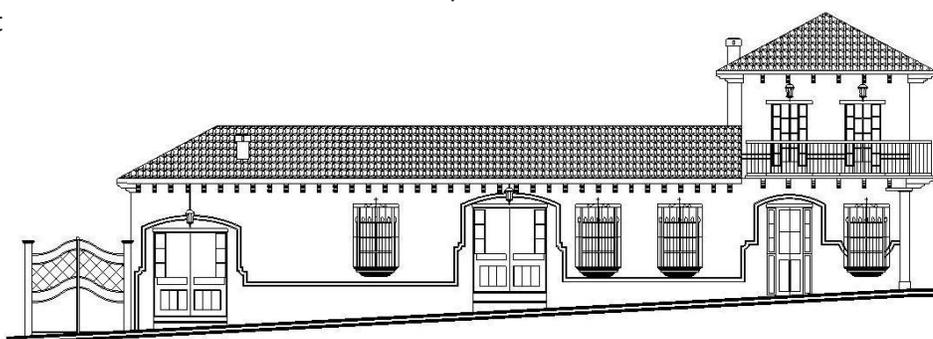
Fachada 7ª. Calle. Elaboró: Mauricio Sosa.
